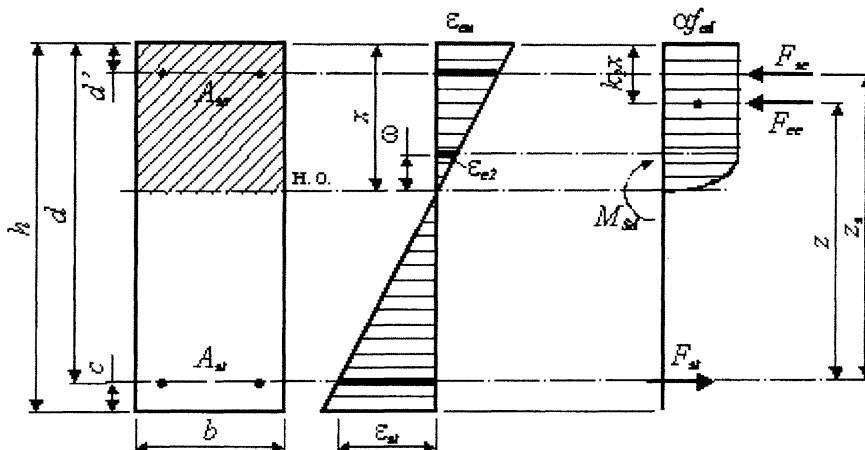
Схема усилий в расчетном сечении с двойной арматурой
